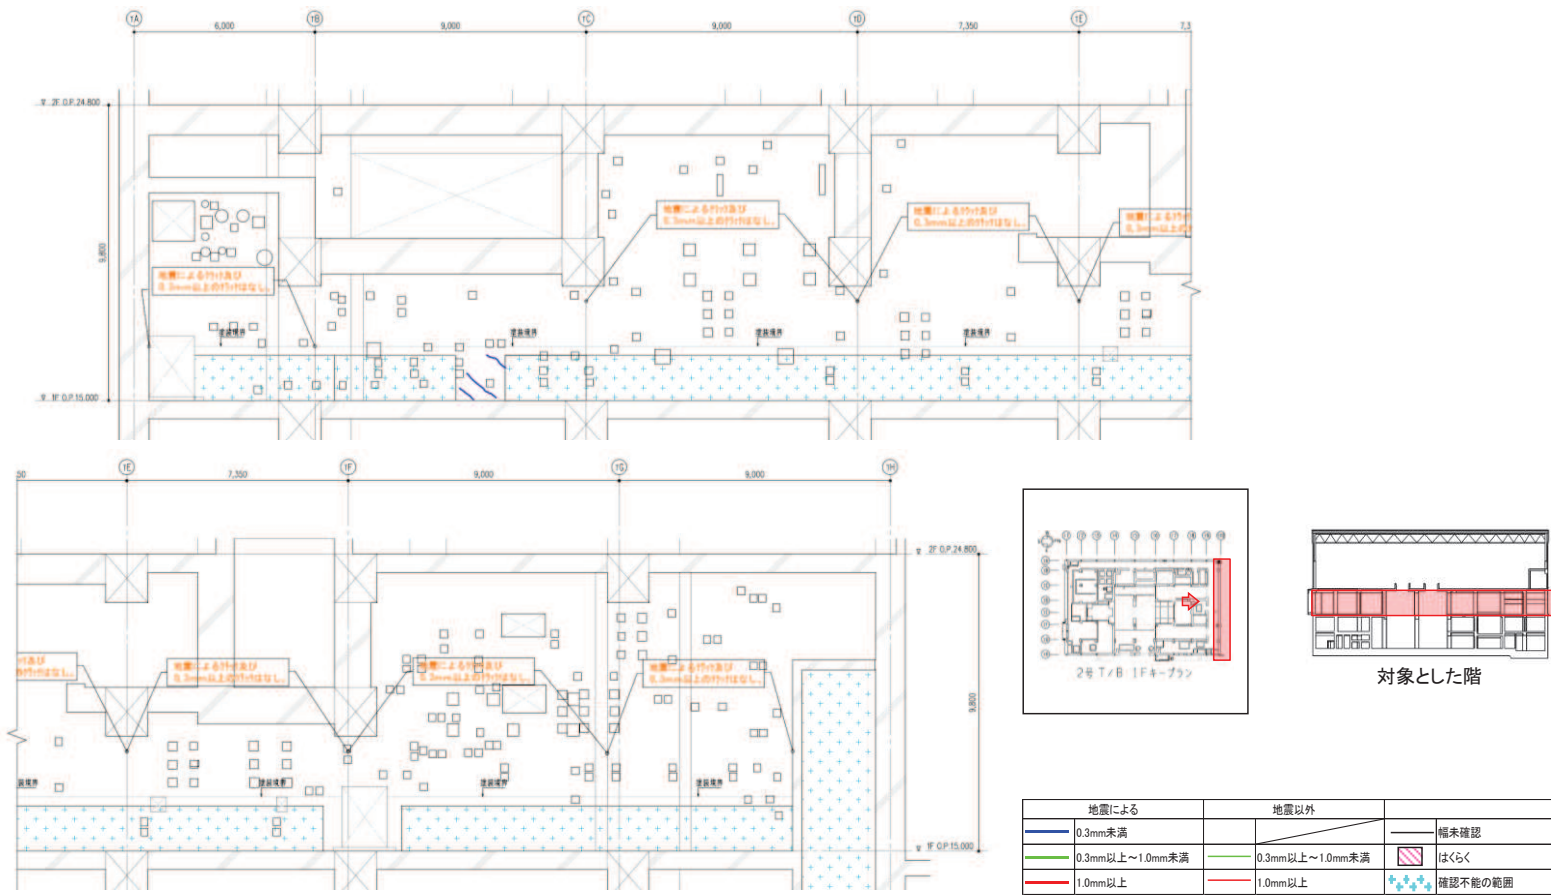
タービン建屋のひび割れ分布 耐震壁 (41) 1階 T10 通り
